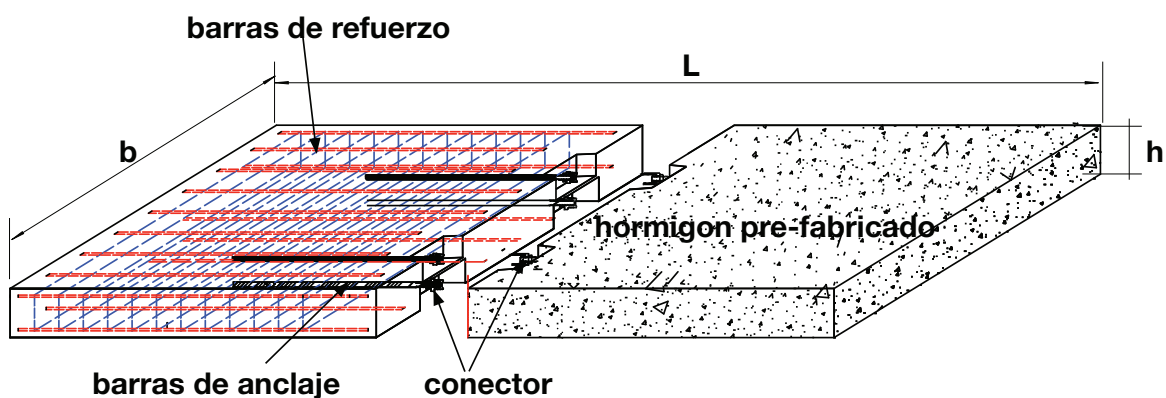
Vigas Pre-fabricada tipo: Vista 3D.
